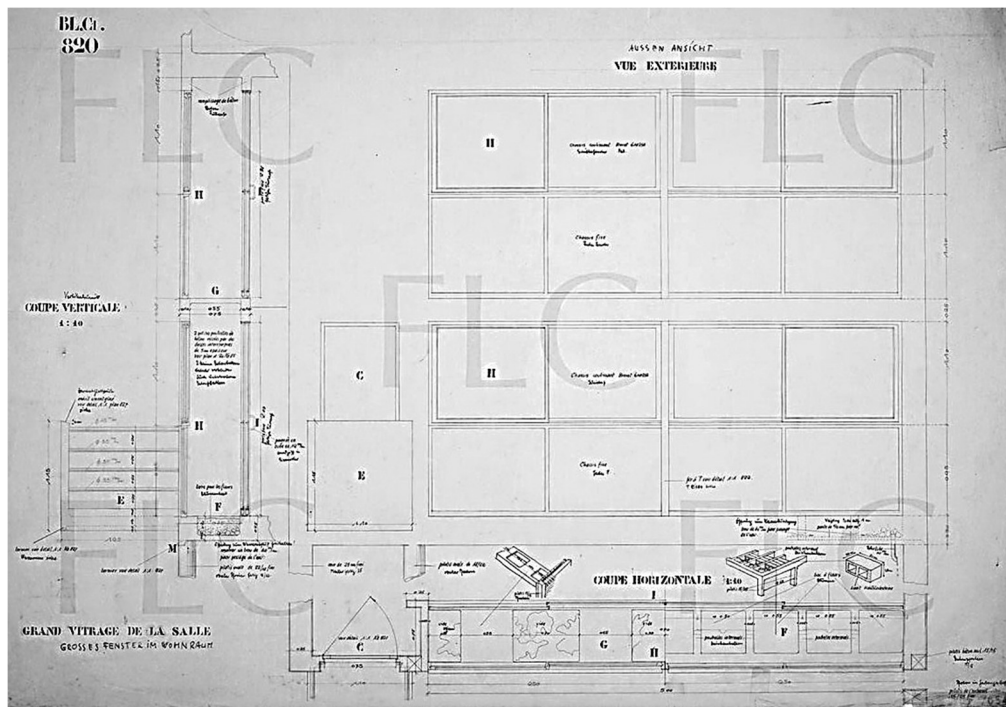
Detalle constructivo del doble acristalamiento de la casa tipo Citrohan. Stuttgart 1926.
